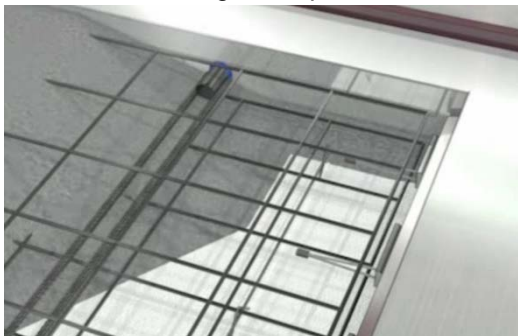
Unión galceada, pilar-panel, Ref. PAVI
